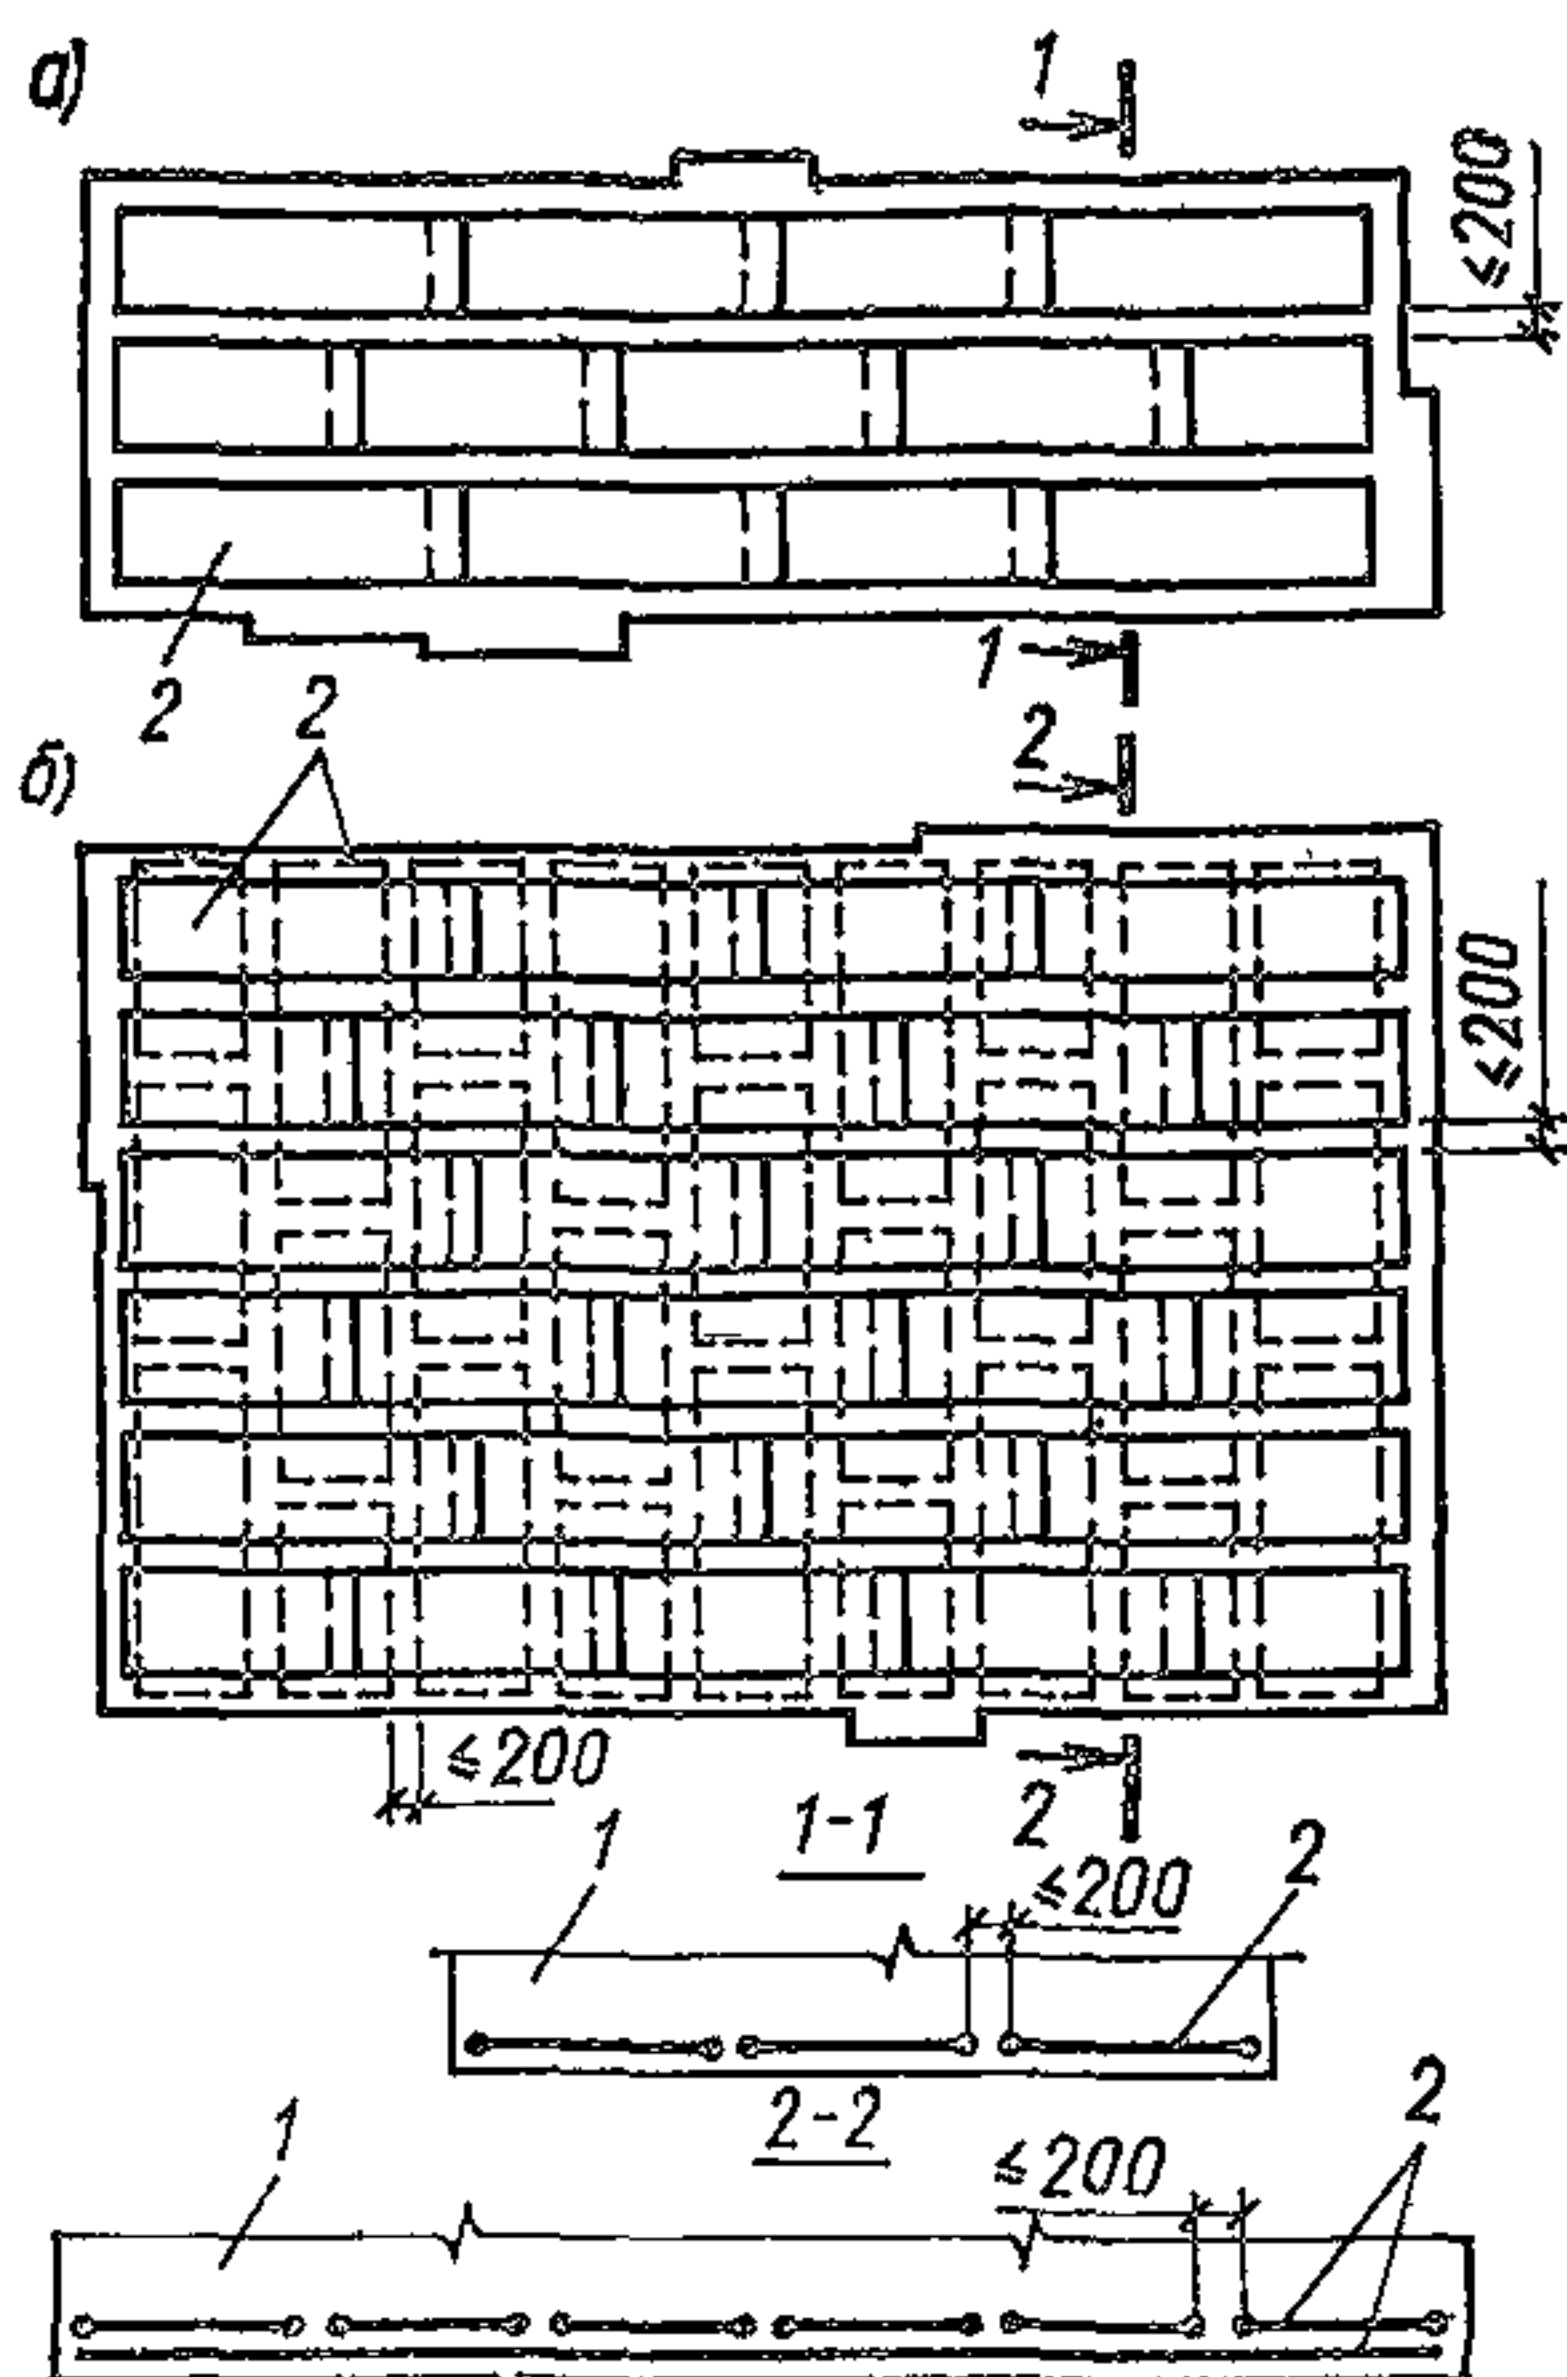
Армирование массивных фундаментов оборудования противосадочной арматурой в уровне подошвы фундаментов
